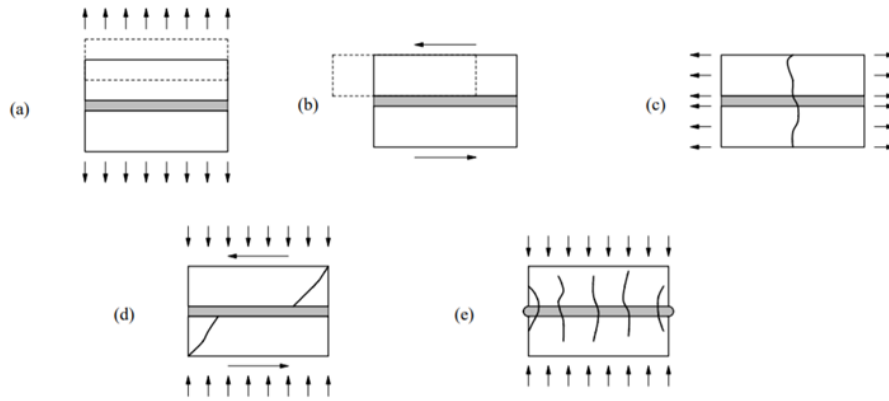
(a)-Fallo a tracción de la junta; (b) Deslizamiento en la junta; (c) Fallo por fisuración en ladrillo a tracción; (d) Fallo por fisuración en tracción diagonal en ladrillo; (e) Fallo por aplastamiento [41]
